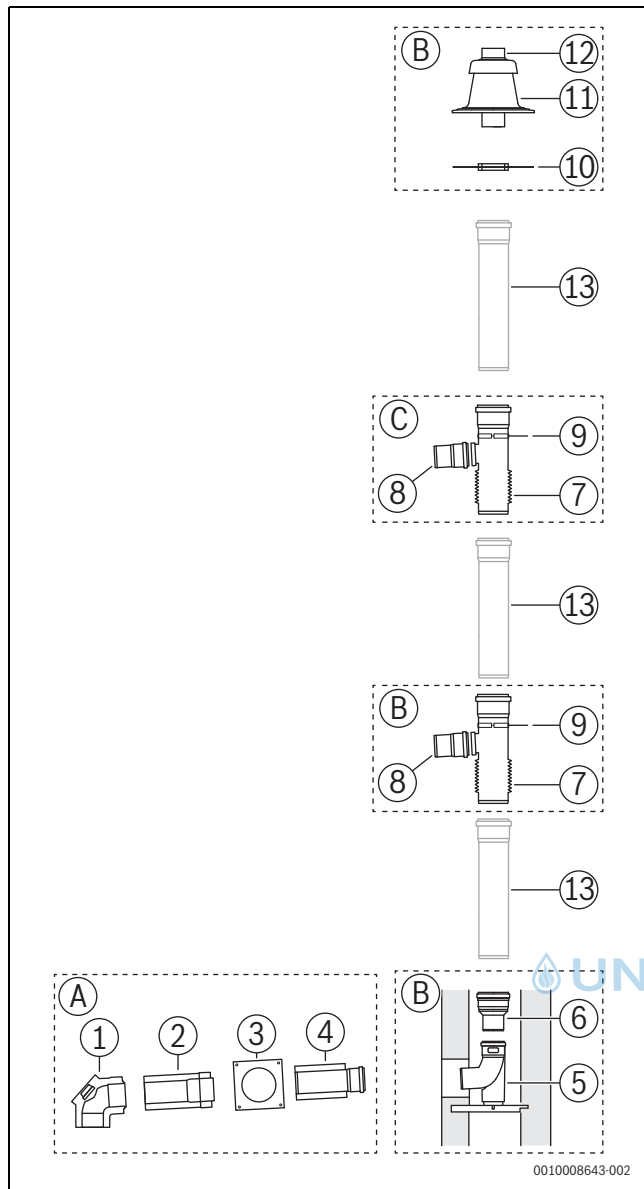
Bauteile des Bausatzes Mehrfachbelegung
